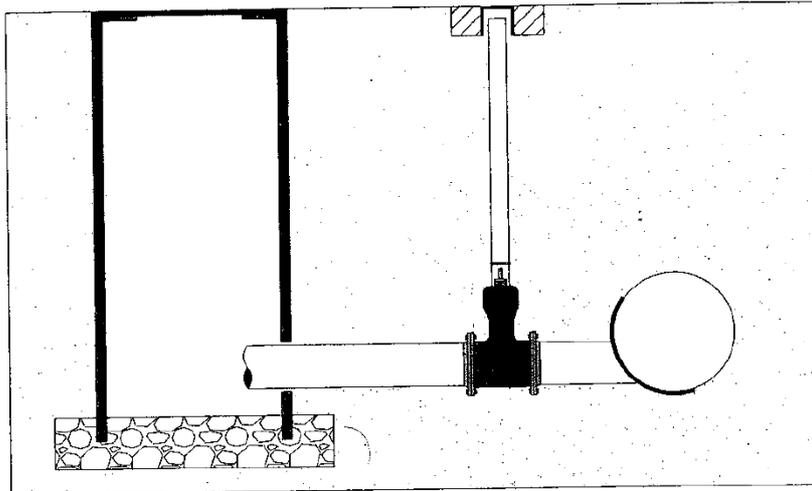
Coupe-type d'un ouvrage de vidange (source : Atlantic'eau)
